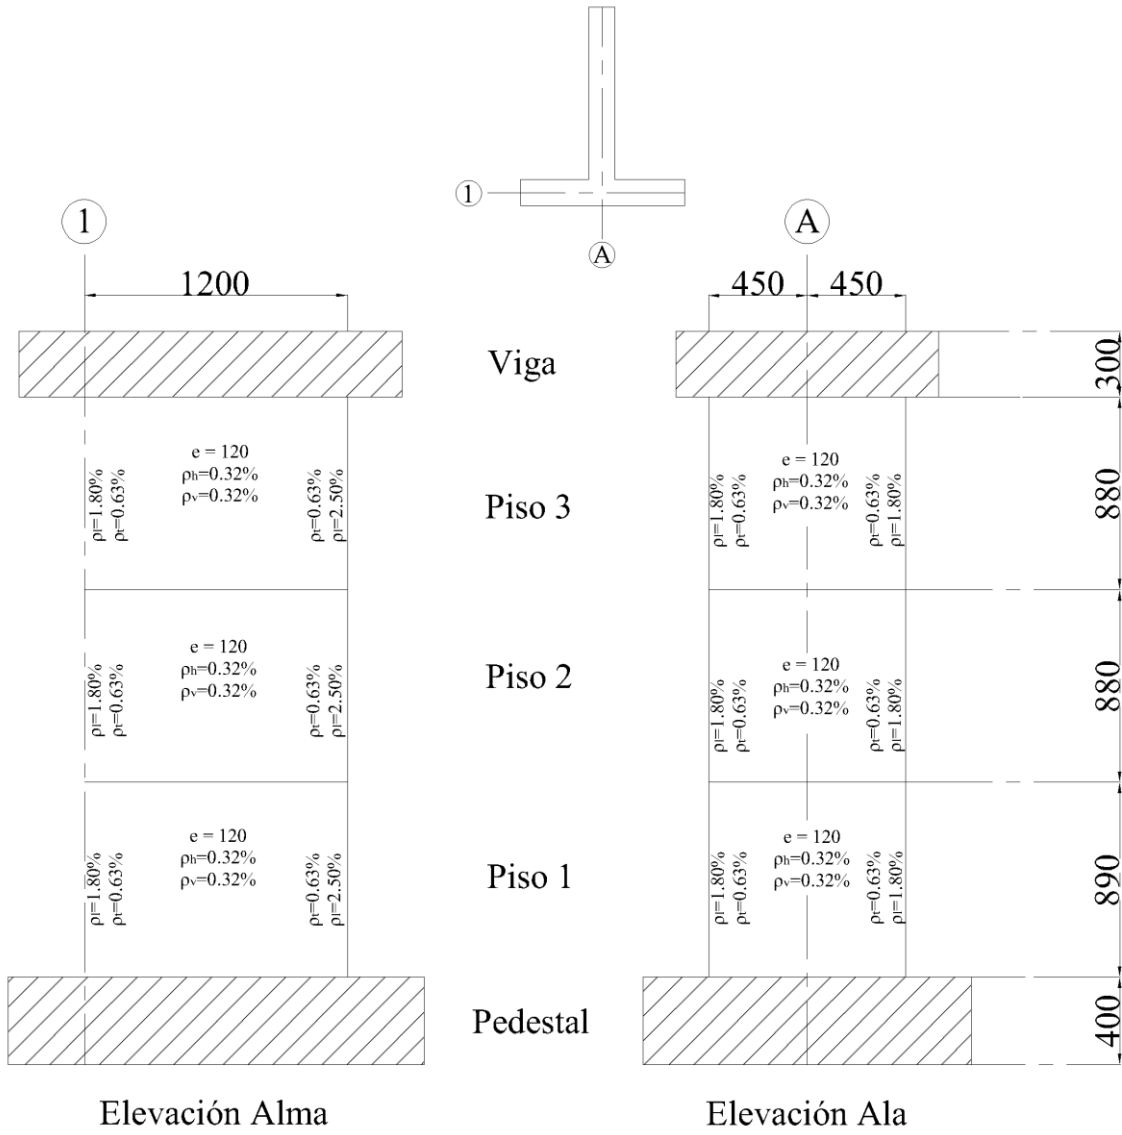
Dimensiones y cuantías de acero en el muro de ensayo ET1.
